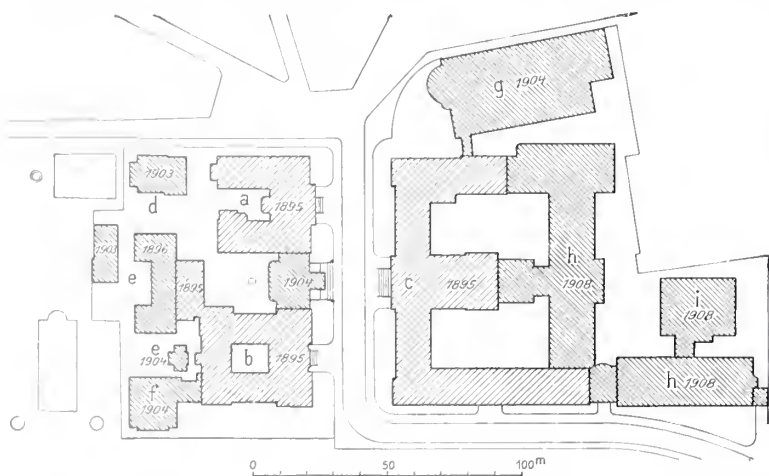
Gesamt-Lageplan der Techn. Hochschule Darmstadt. — 1 : 3000.
